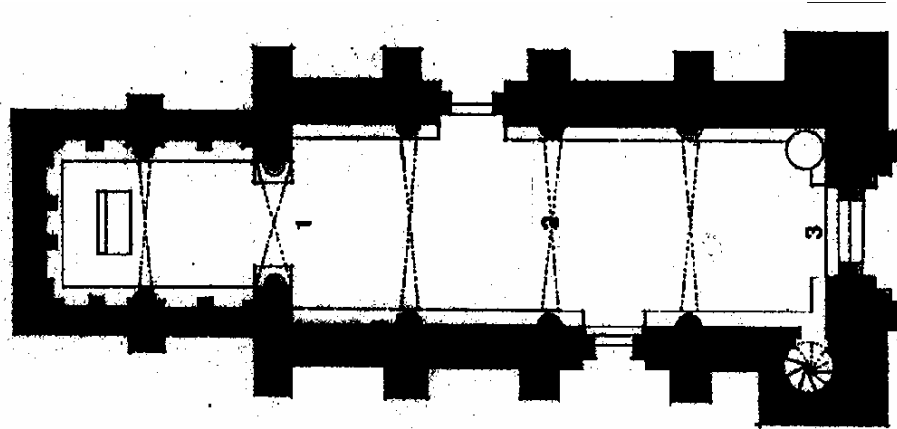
Planta da igreja de São Martinho de Cedofeita (Porto) [3]
